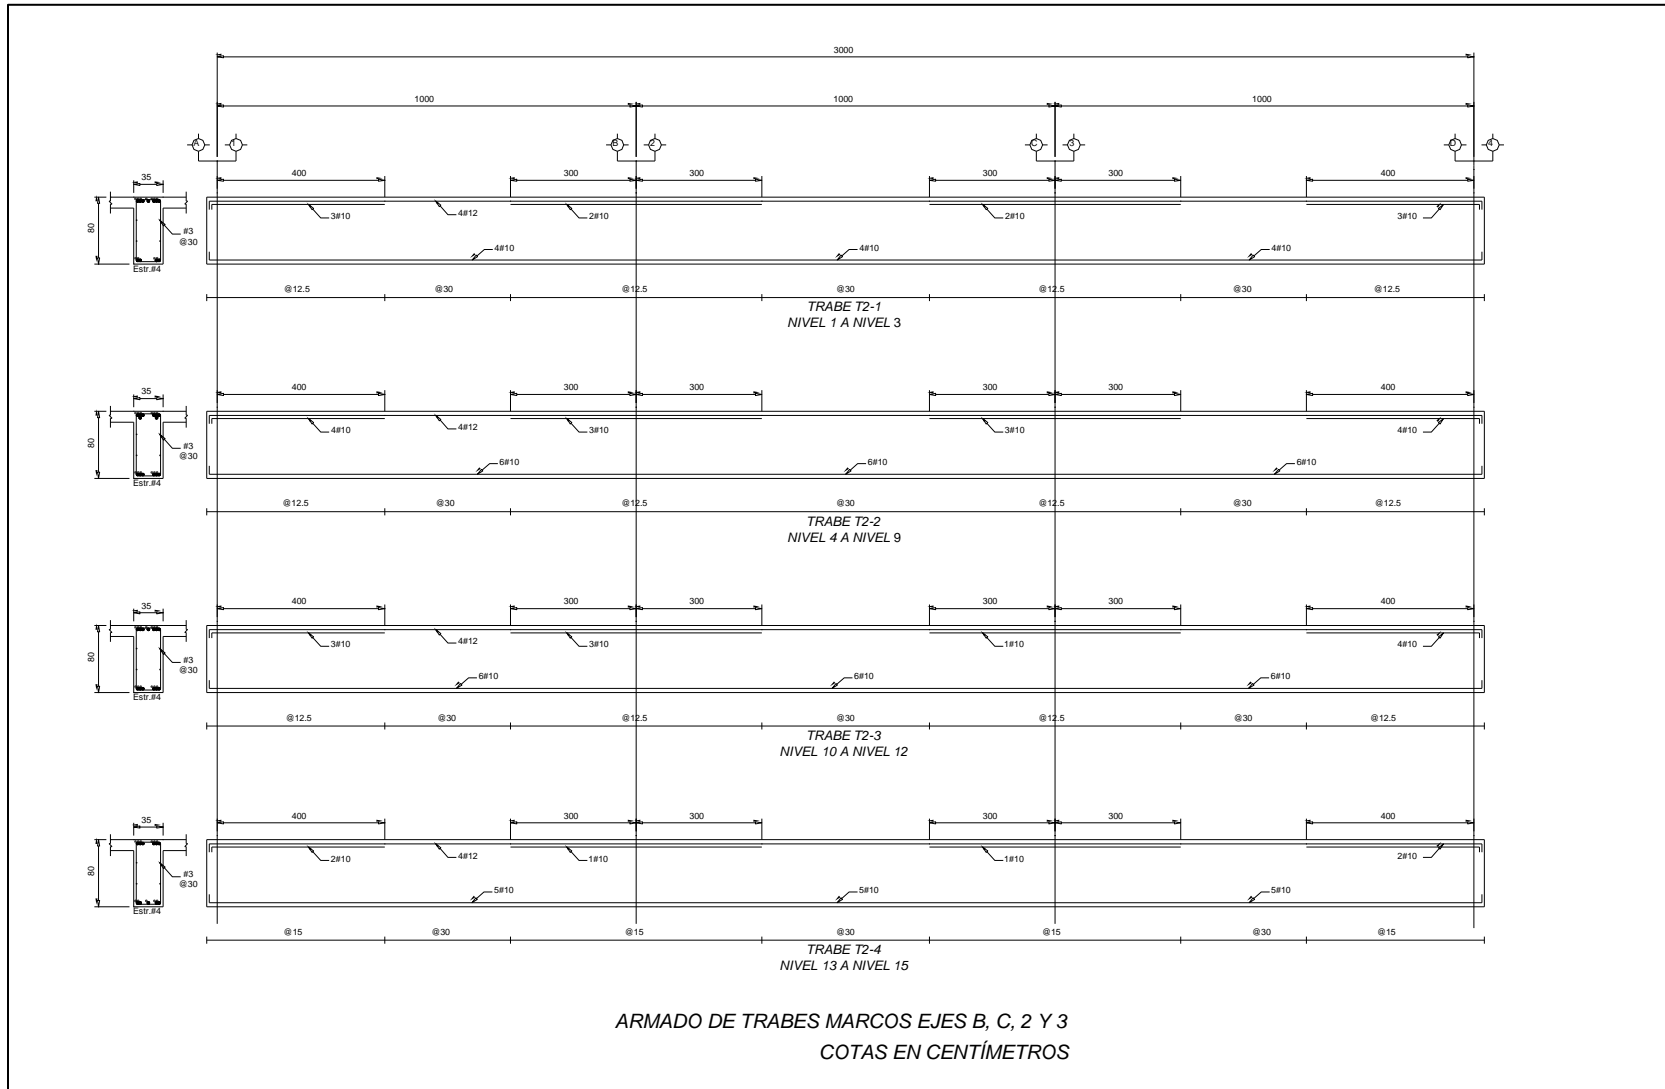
Detalles estructurales del edificio de 15 niveles diseñado con el ACI318-08
